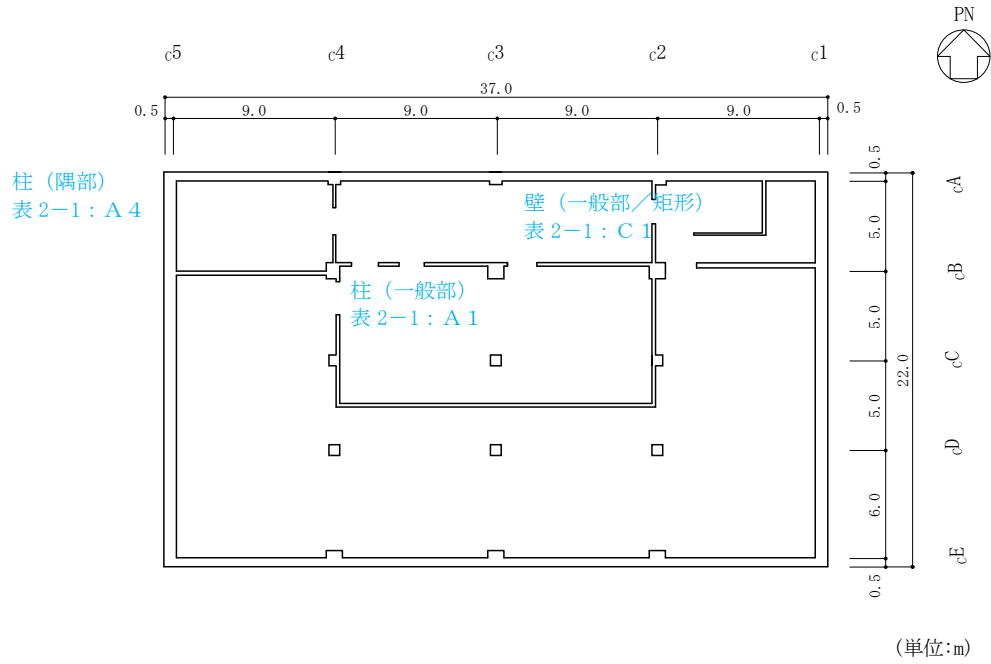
(3) 制御室建物の概略平面図 (EL 12.8m)
